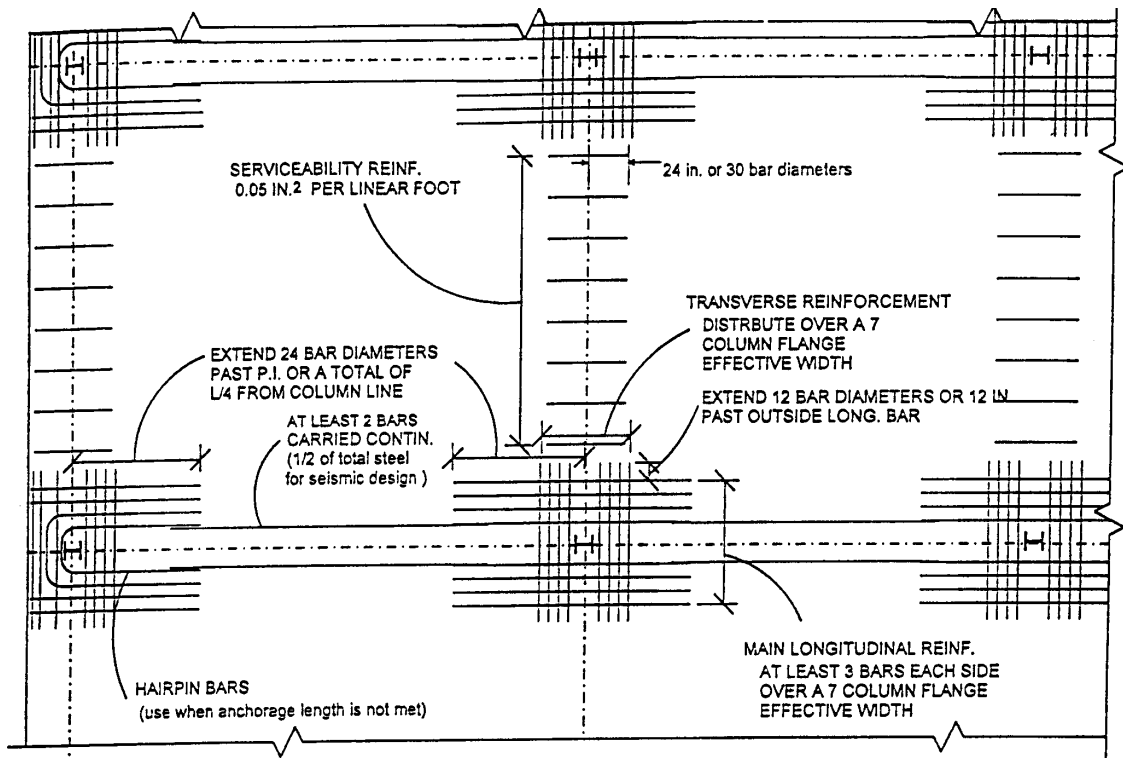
Détails d'armaturage de dalle dans un dimensionnement sismique de poutre mixte avec assemblage mixte à résistance partielle (PR-CC) - ASCE (1998).
